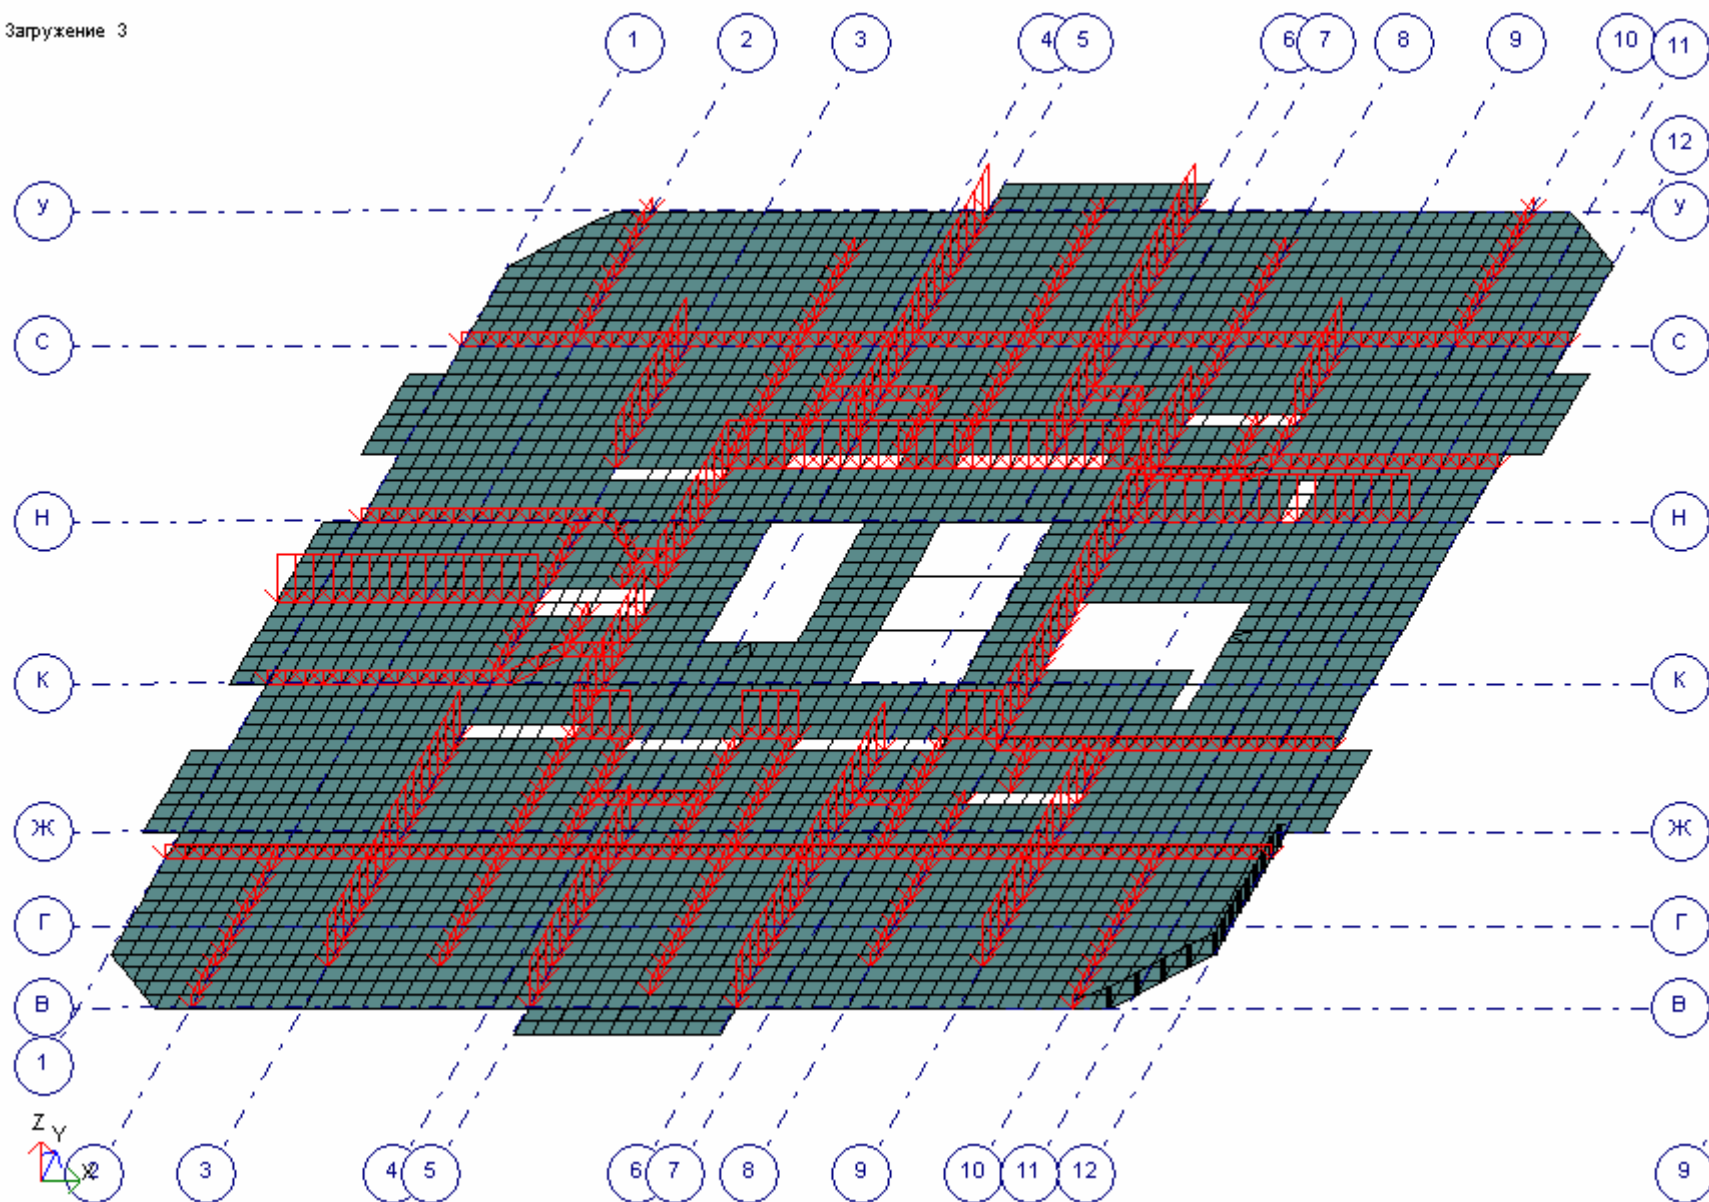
Действие перегородок на перекрытие типового этажа
